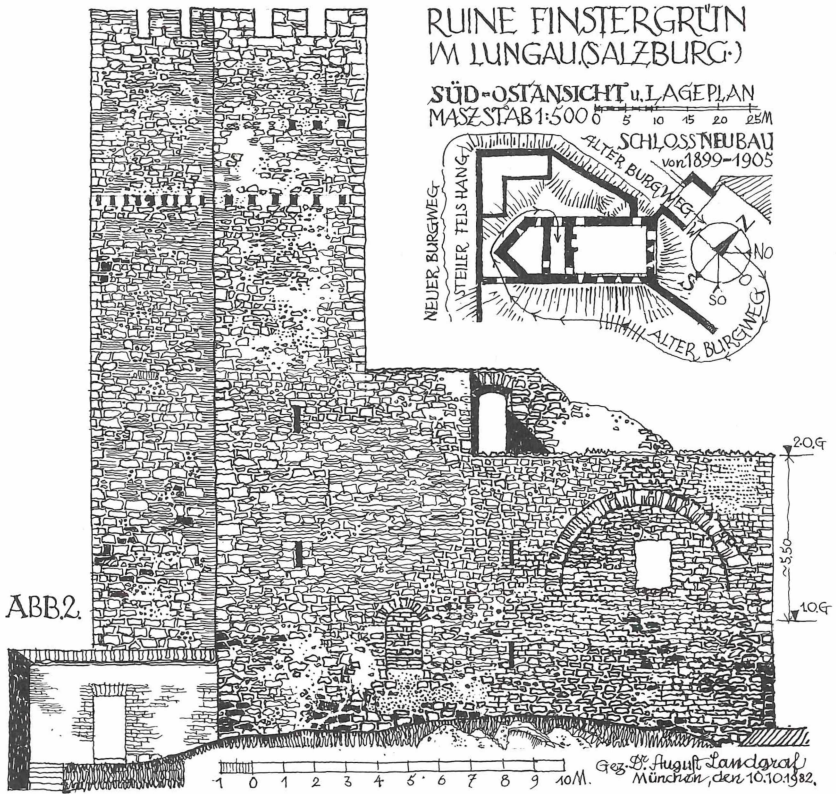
Bestandsplan: Südostansicht und Lageplan.
